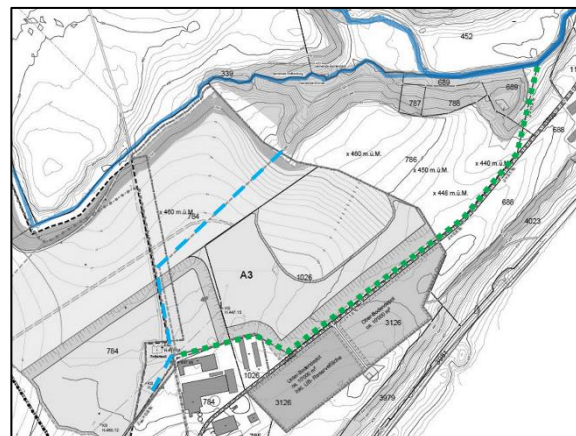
Ausschnitt aus dem Plan P-4, Betriebsplan (26.10.2020) mit zusätzlicher Entwässerung und Einleitung im Rahmen der «Weiterführung Ost» (grün gepunktet).
